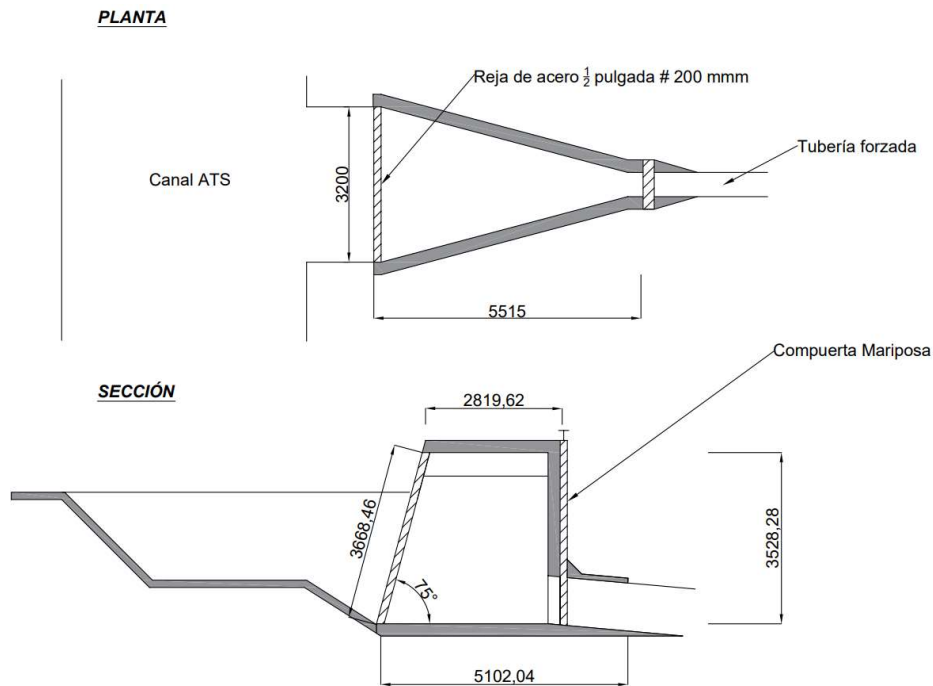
Sección en planta y alzado del depósito de capacidad mínima en el caso de central fluyente
